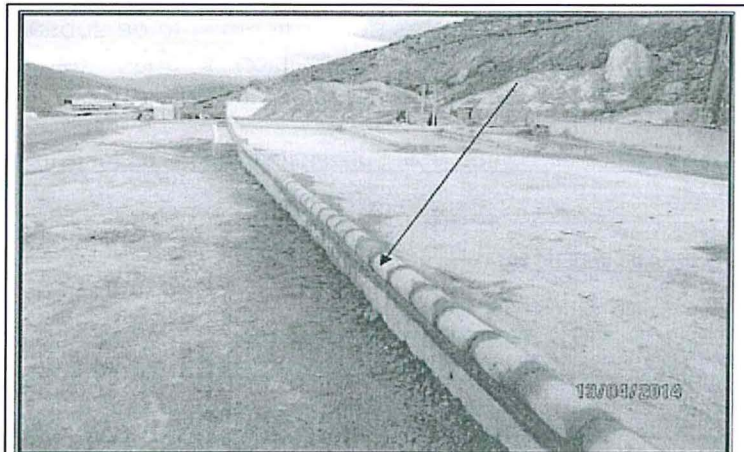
Subsanación de Hallazgo 9 – Se ha construido una berma de contención de aproximadamente 15 cm de alto, alrededor de la plataforma de lavado
